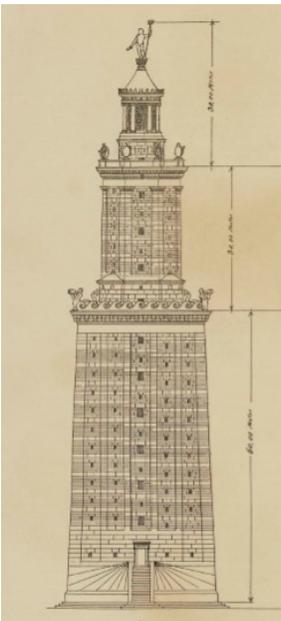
Pharos, Grundriss (Rekonstruktion).
